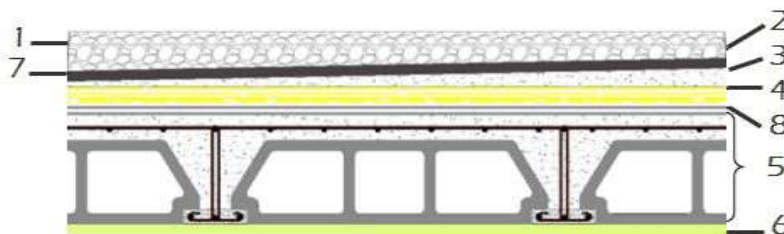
Coupe transversale du plancher terrasse inaccessible.
